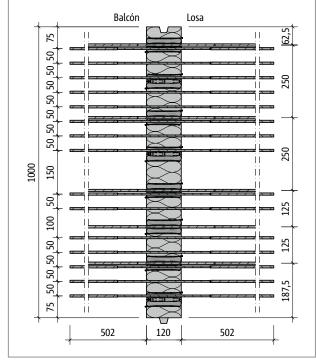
Schöck Isokorb® XT tipo K-M6: Plano del producto
